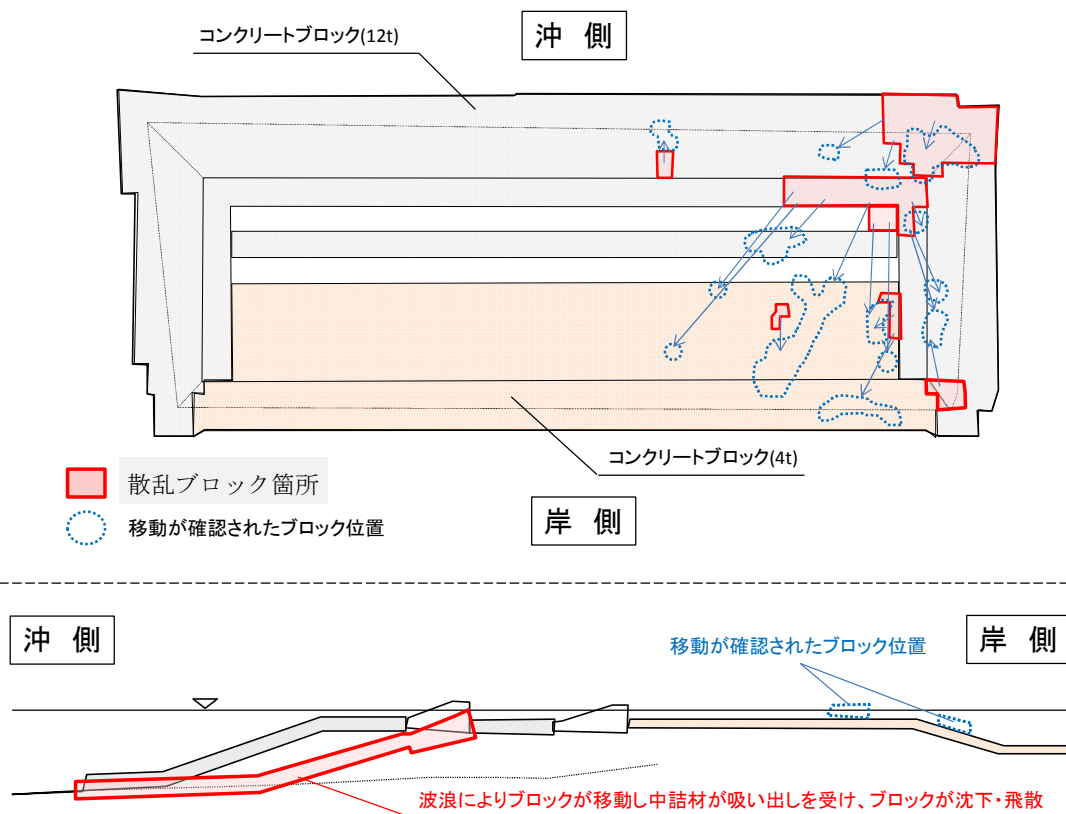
被災状況（上図：平面図イメージ、下図：断面図イメージ）
